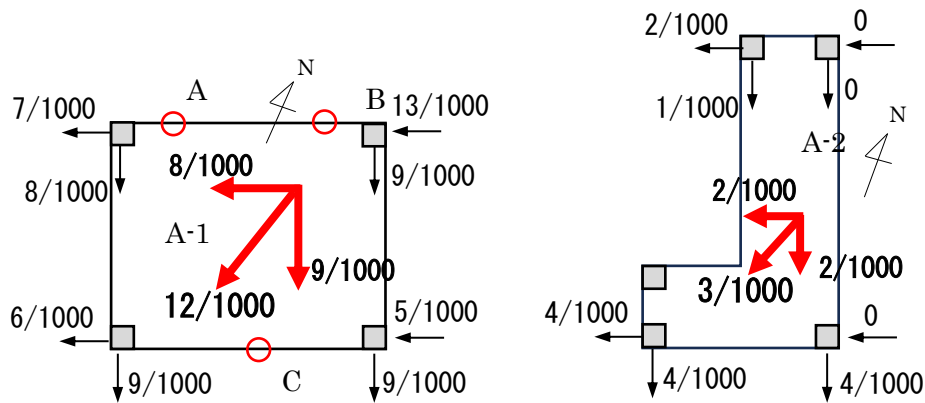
建築物 A-1 および A-2 の概略平面図
